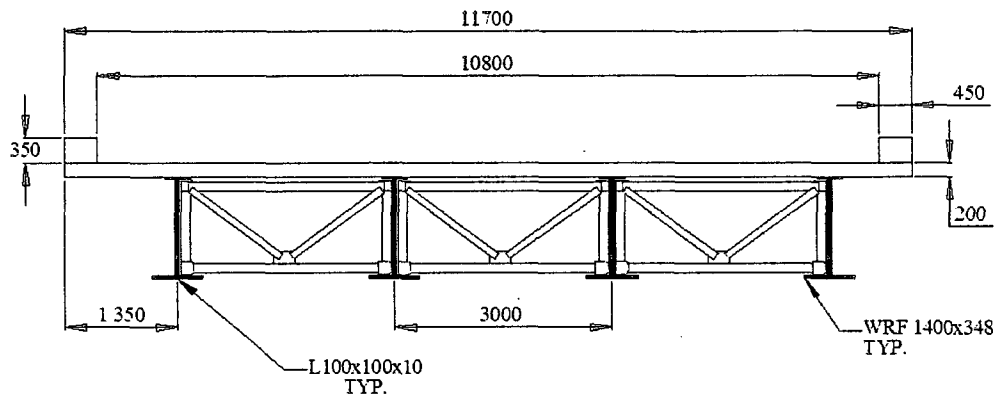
Coupe transversale du pont modèle à poutres d'acier
